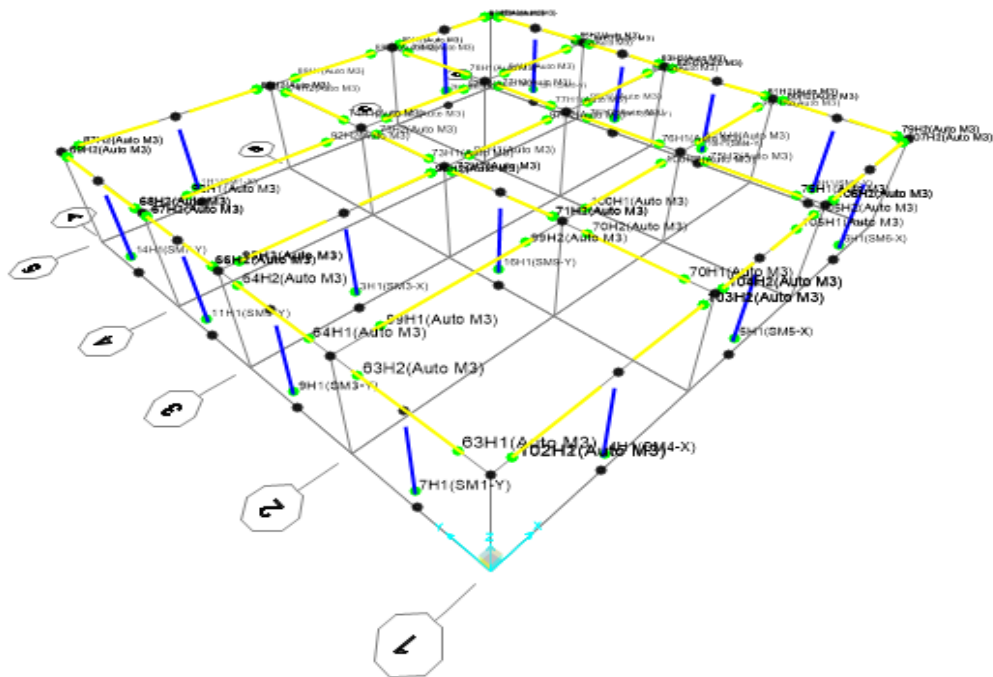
Representación de las rotulas en los muros y en las vigas en el SAP 2000.
